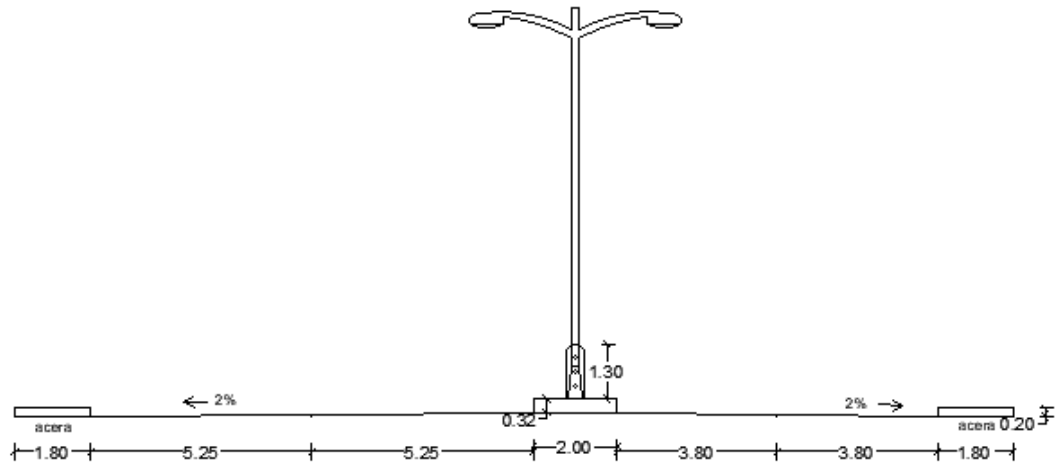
Sección transversal Tramo 2-3 Calle Este Oeste 101
